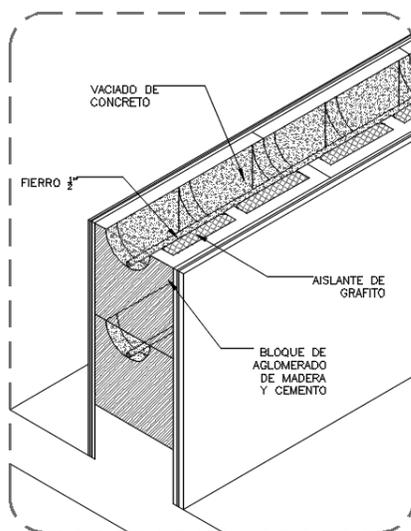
Detalle isométrico (sin escala), muro exterior de bloques CMC con interior de aislante de grafito, Climablok. Fuente: Elaboración propia.
